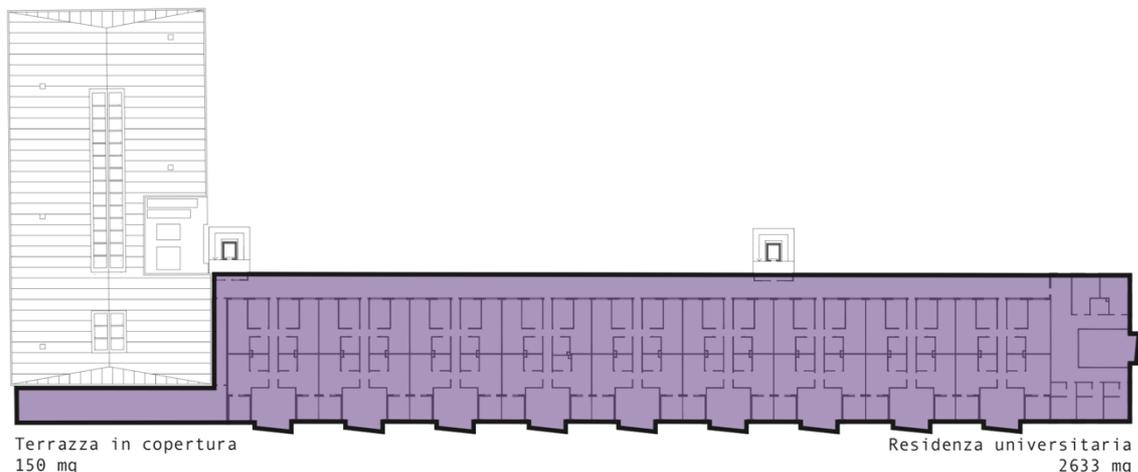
Distribuzione al secondo piano. Pianta non in scala. Estratto da tavola 5.
